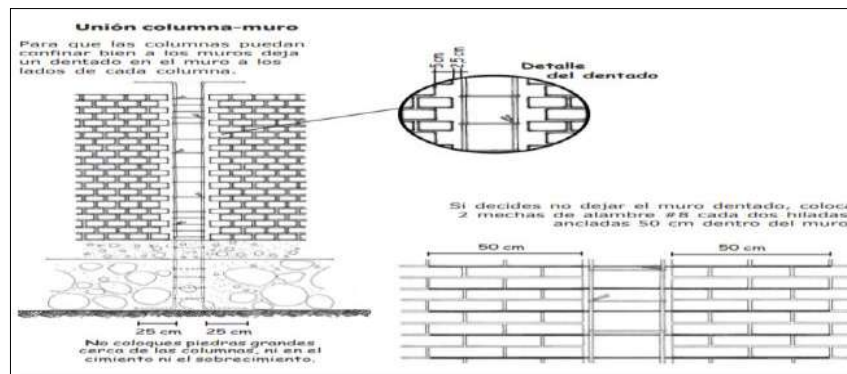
Construcción y mantenimiento de viviendas de albañilería.
